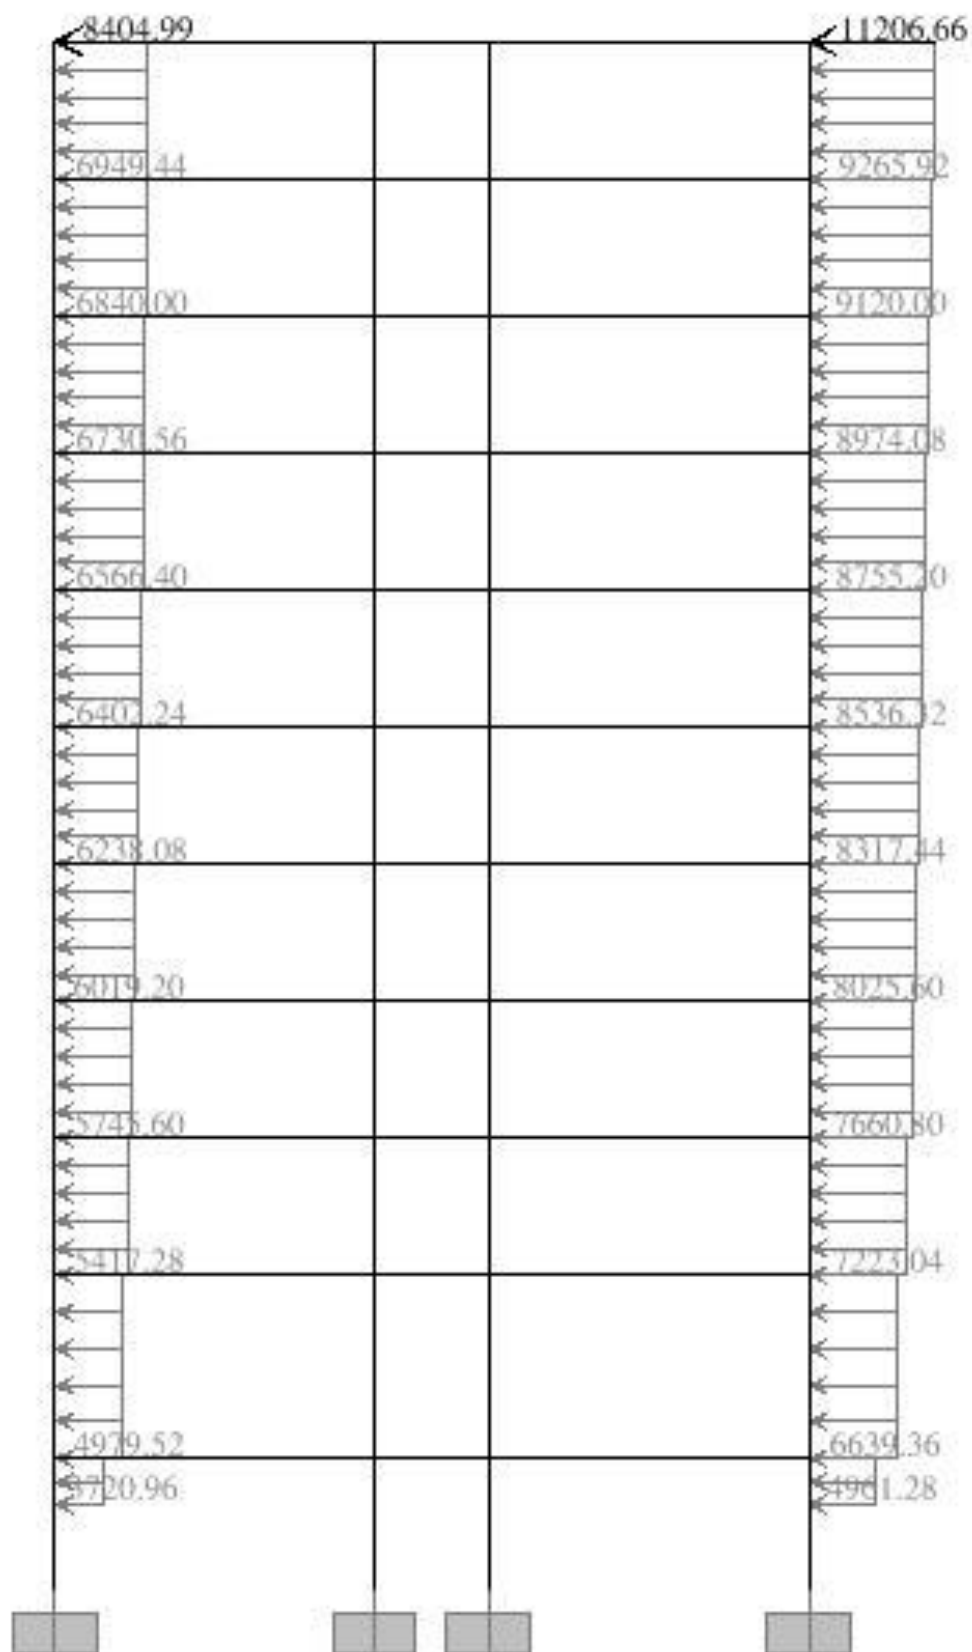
Sơ đồ chất tải (Tĩnh tải)
